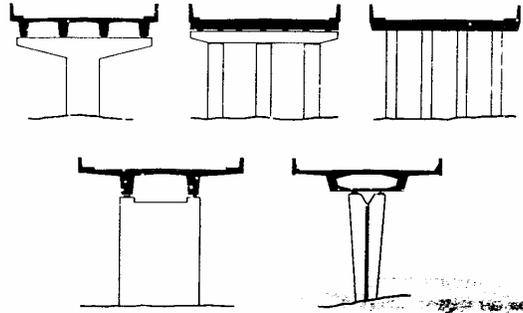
Algunas secciones transversales típicas en viaductos.
